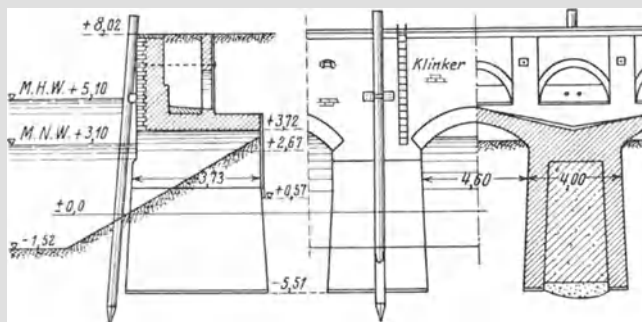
a u. b. Kaimauer auf Brunnen, Hamburger Hafen (Kaiserkai). Maßstab 1:330.
